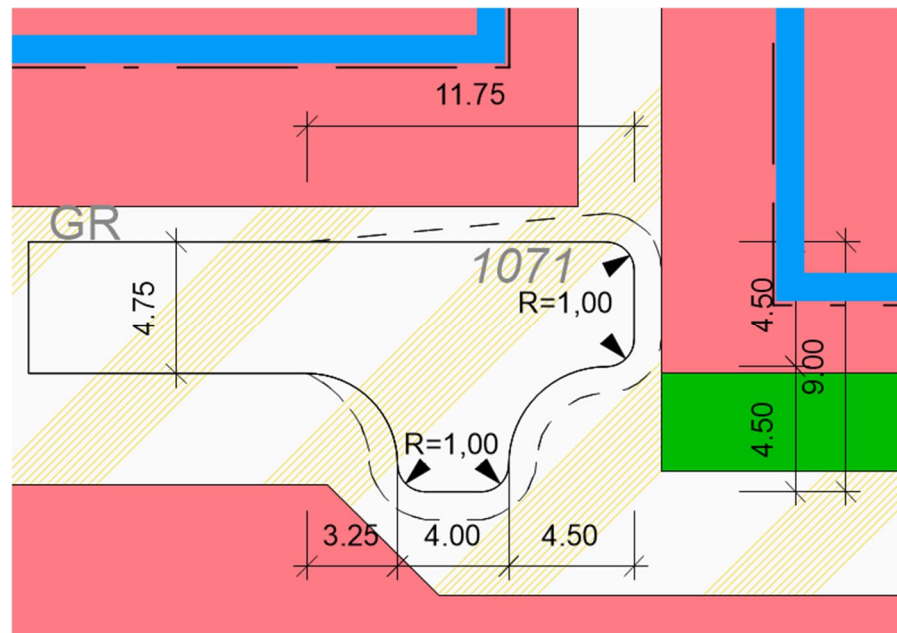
Darstellung der Wendemöglichkeit in der Planstraße C
